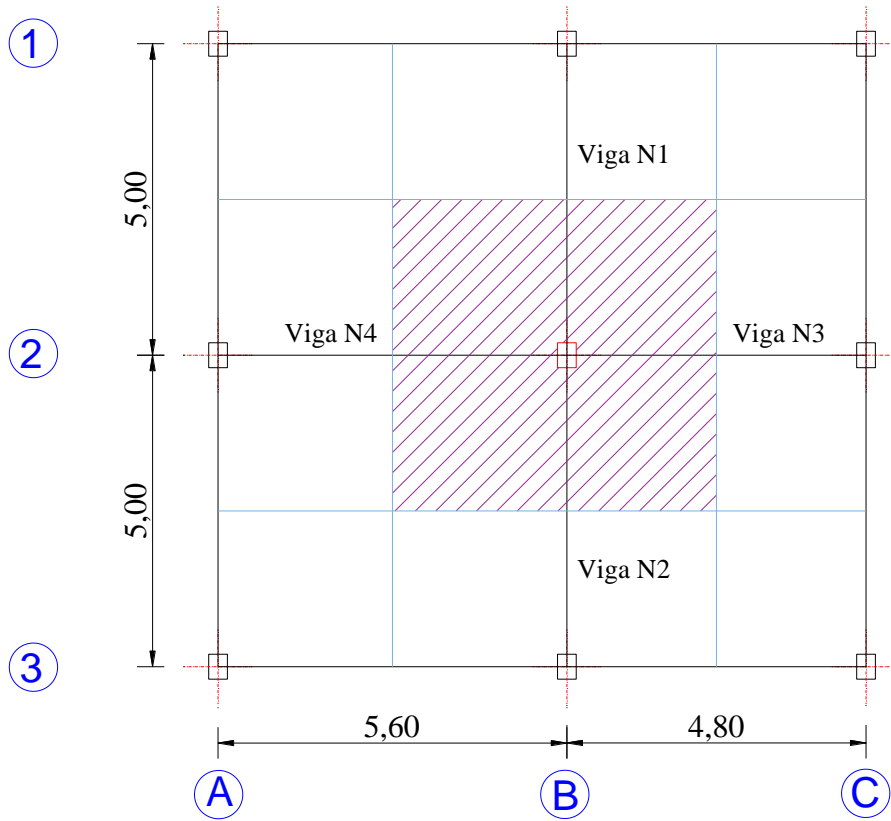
Vigas principales dentro del área cooperante de la columna B2.
